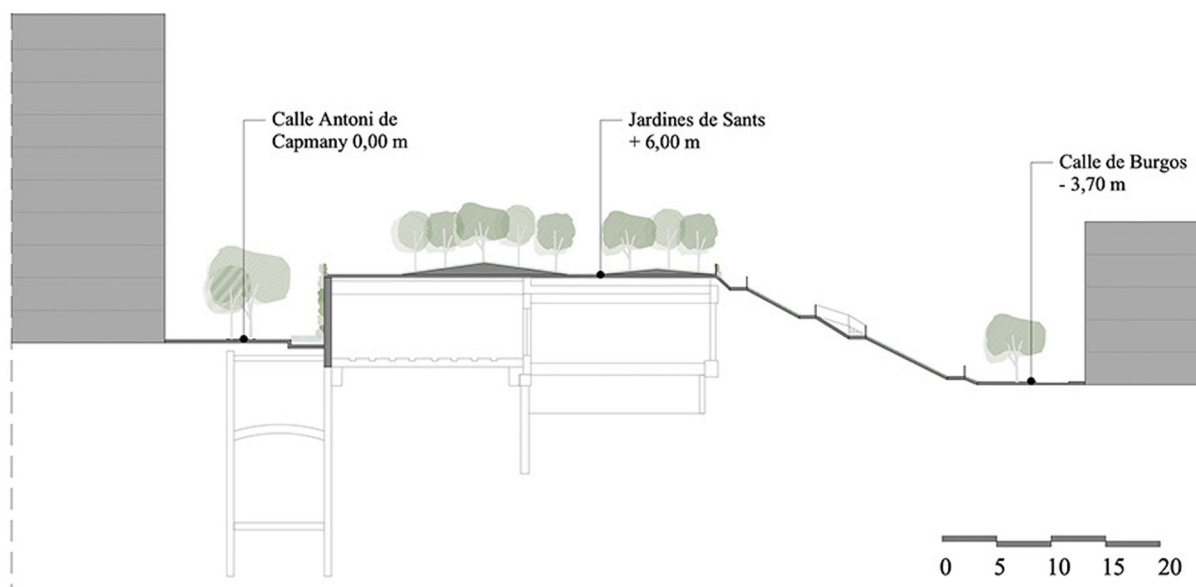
Planta – Sección 2. Segundo punto del recorrido. (2024)
